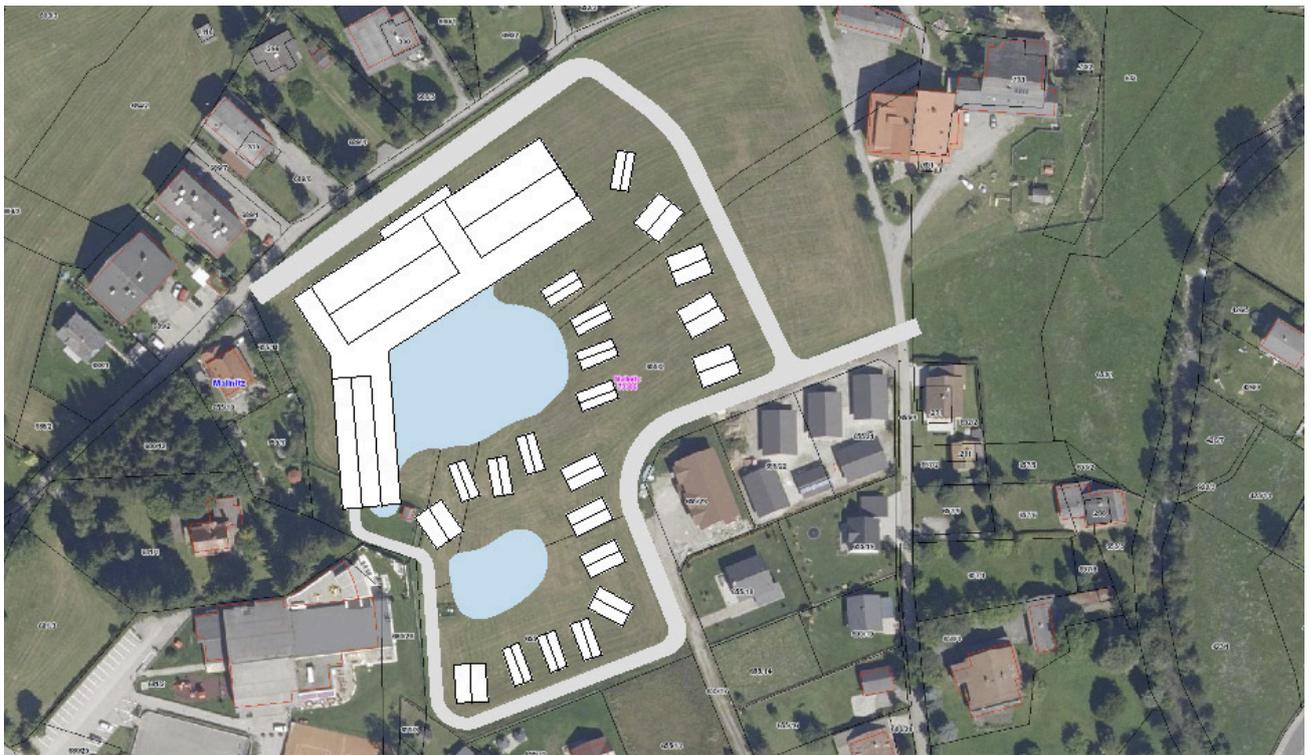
Lageplan Orthophoto, UBOS 4.0 Entwicklungs und Consulting GmbH
